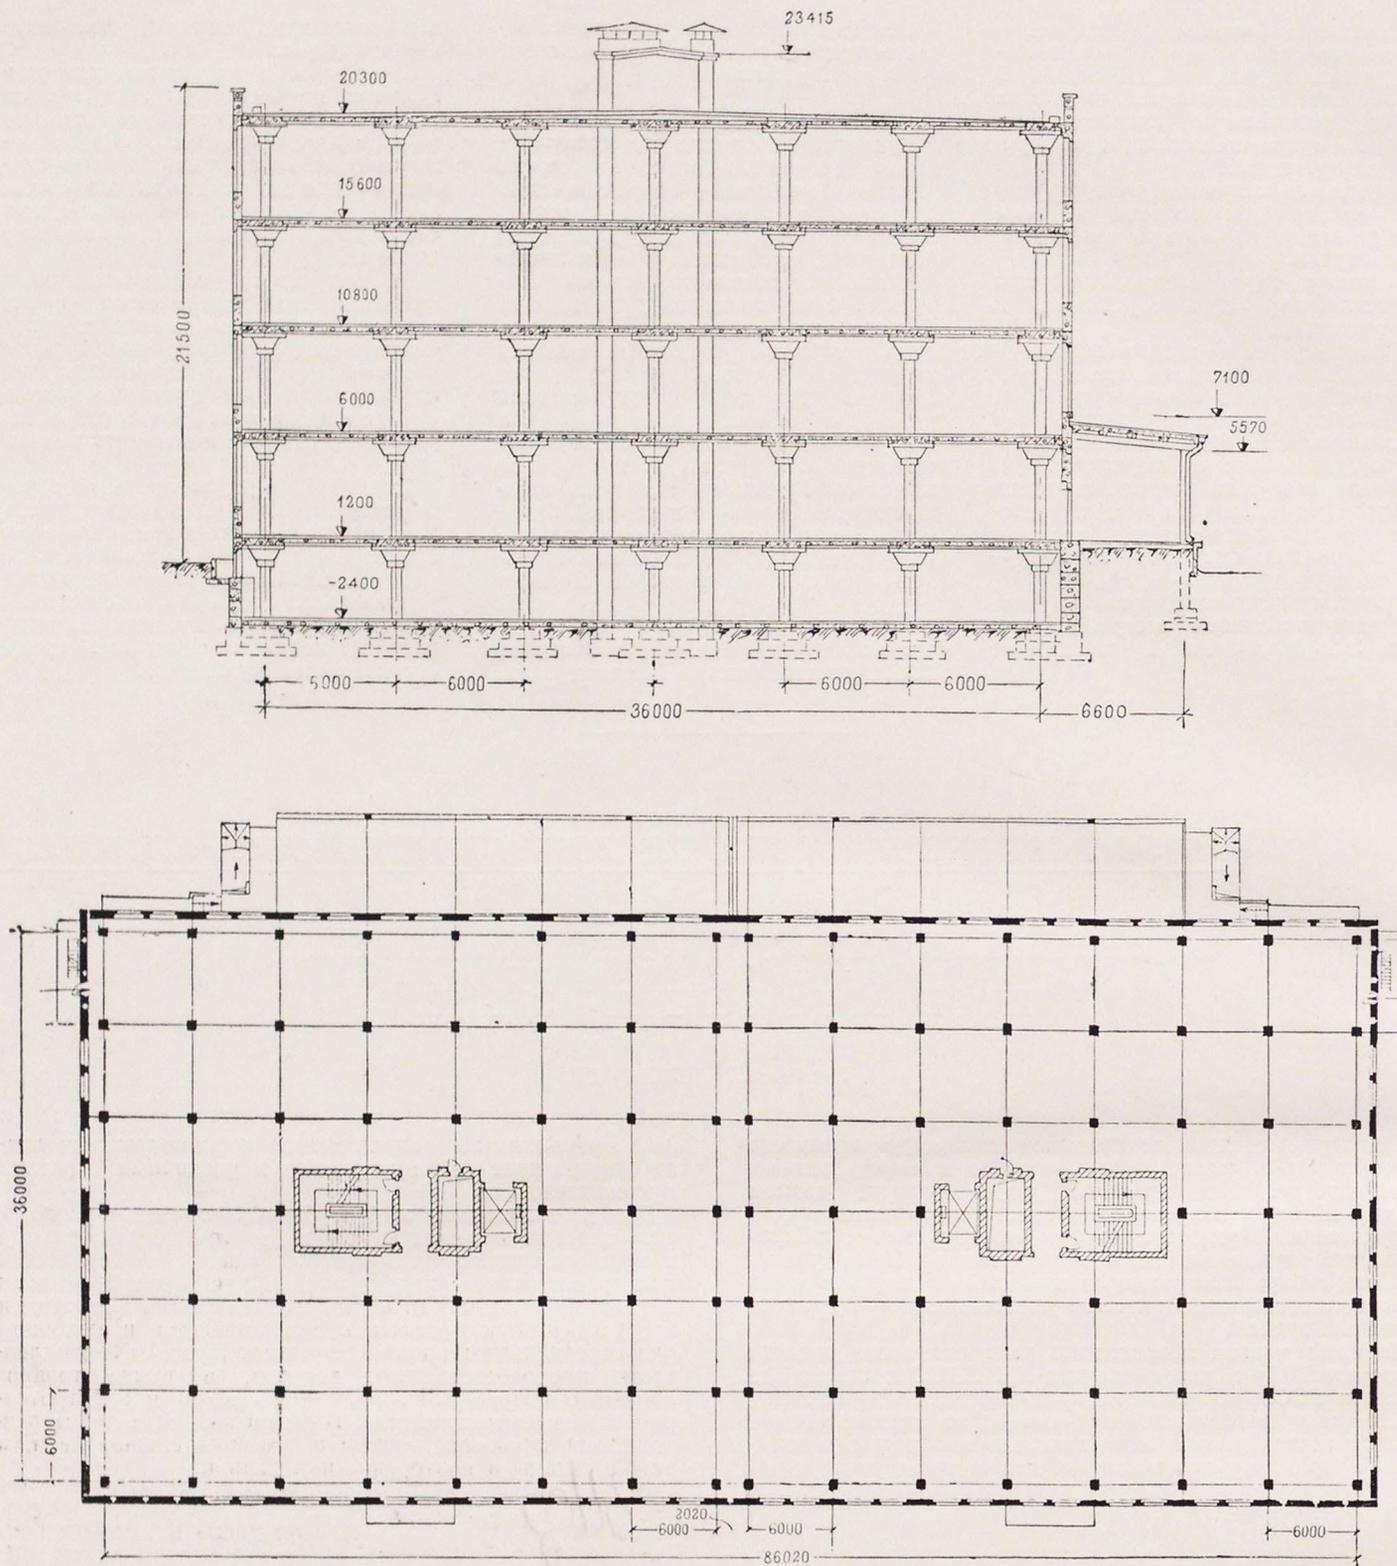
Поперечный разрез и план многоэтажного типового промышленного здания
